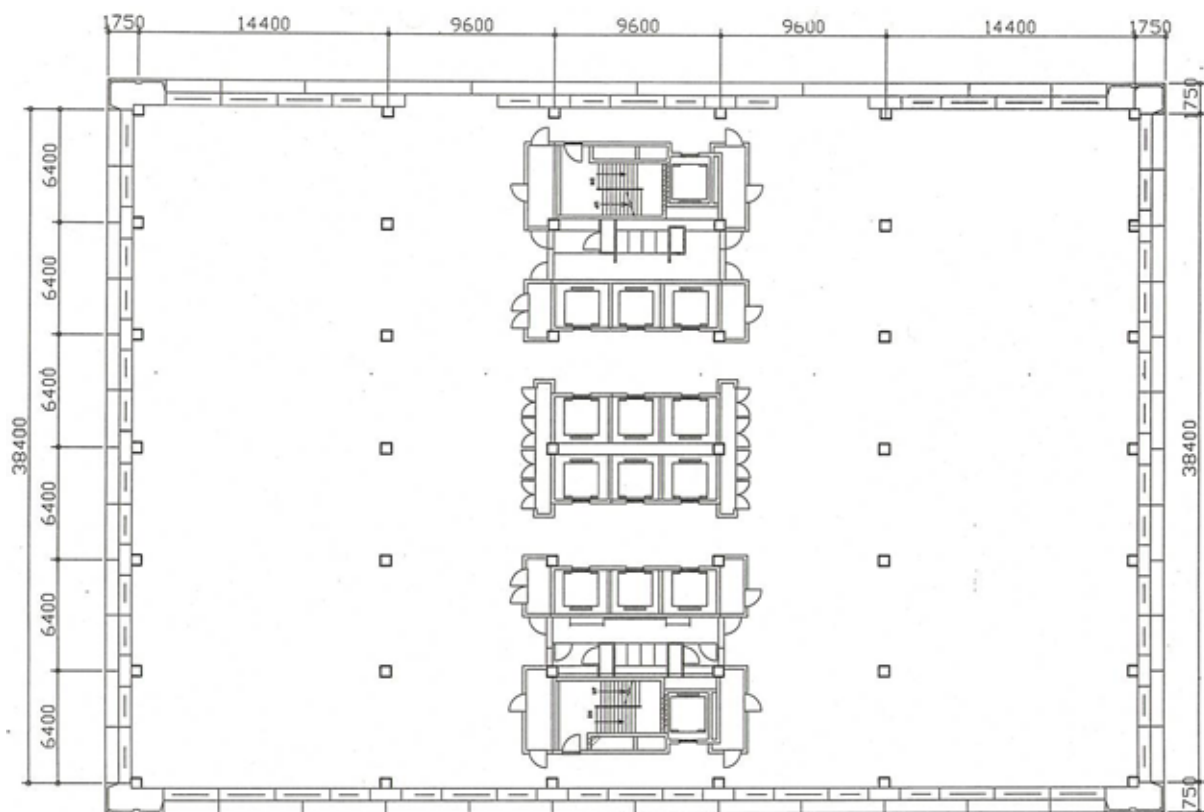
4 基準階（低層階 EV 有）平面図（出典：施工計画書）
